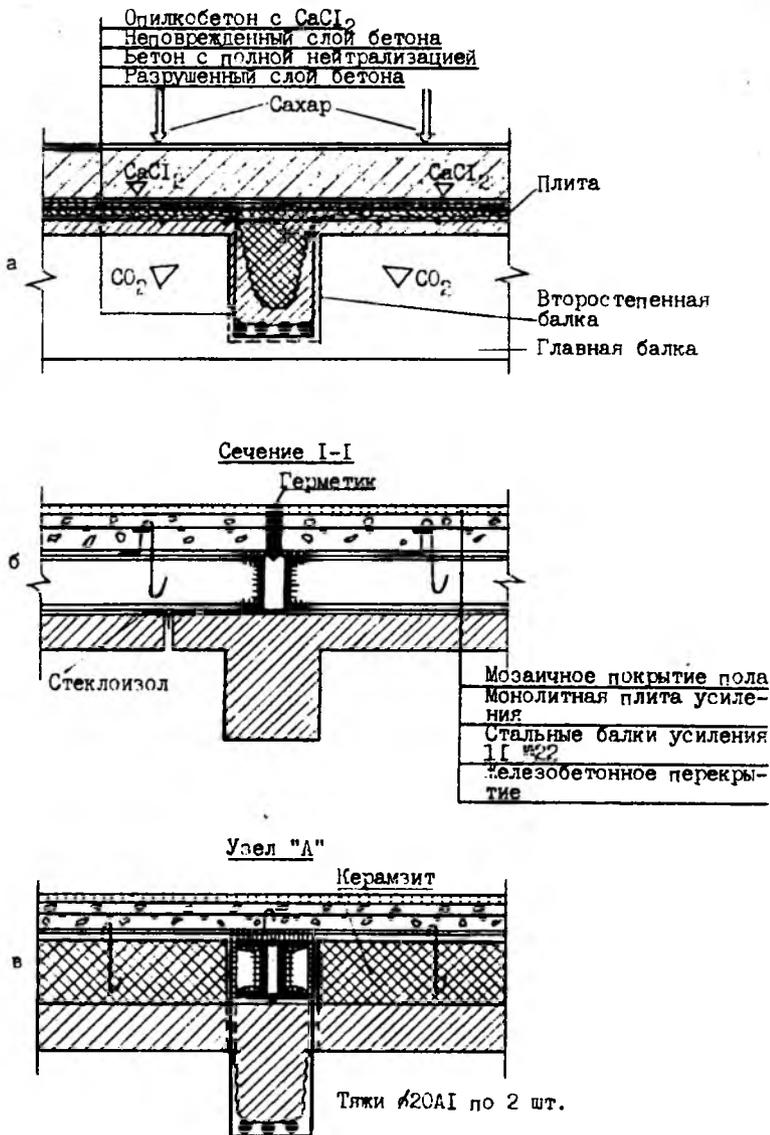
Коррозионное повреждение монолитного железобетонного перекрытия и схема его усиления
